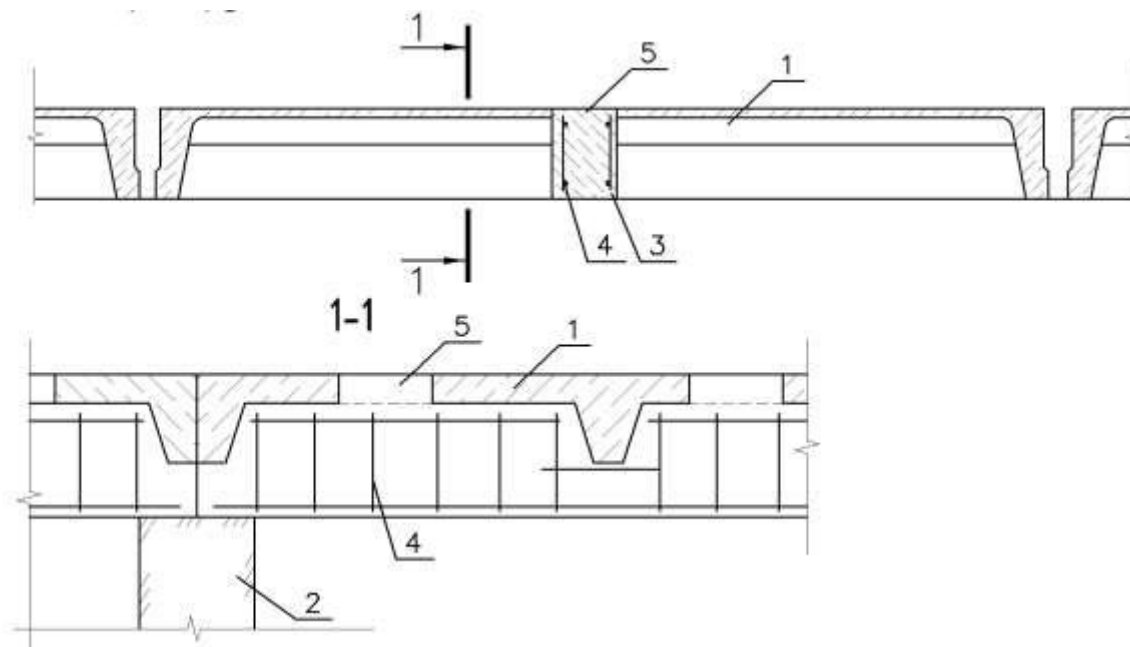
Установка разгружающих балок из монолитного железобетона
